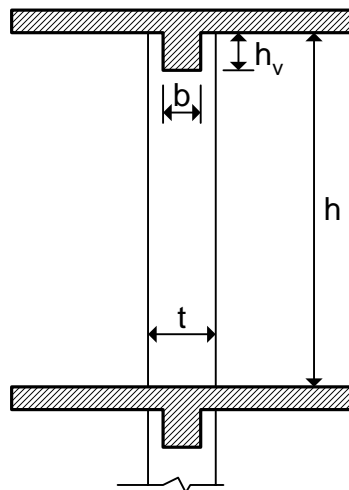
Corte indicando a viga embutida na parede
